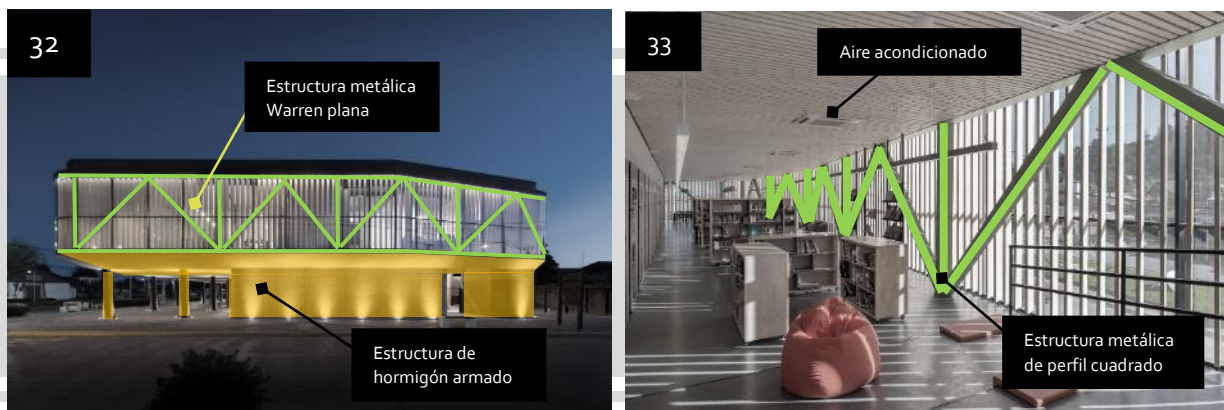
y 33. Exterior e interior del Centro de Cultura de Arauco.
